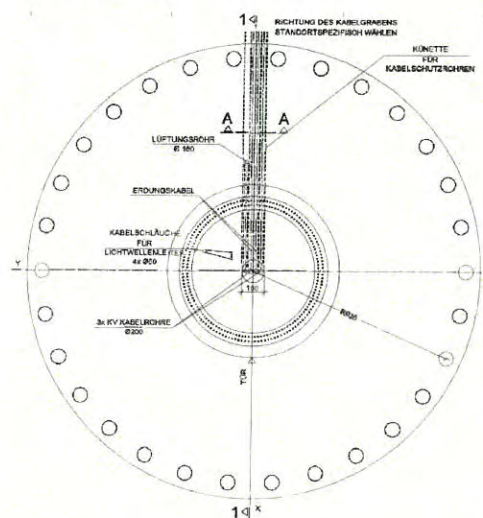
Grundriss der Tiefgründung ohne Auftrieb des Anlagentyps Vestas V150 4.0/4.2 MW, MK3E, WZ2GK(S) 166 m
